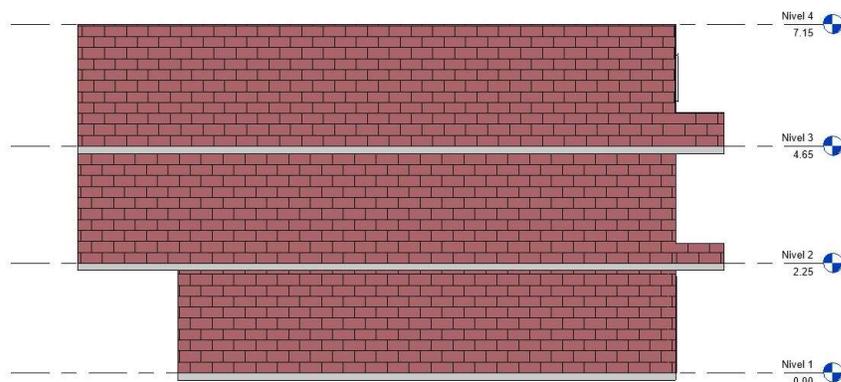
Vista lateral de la edificación. Fuente: elaboración propia
